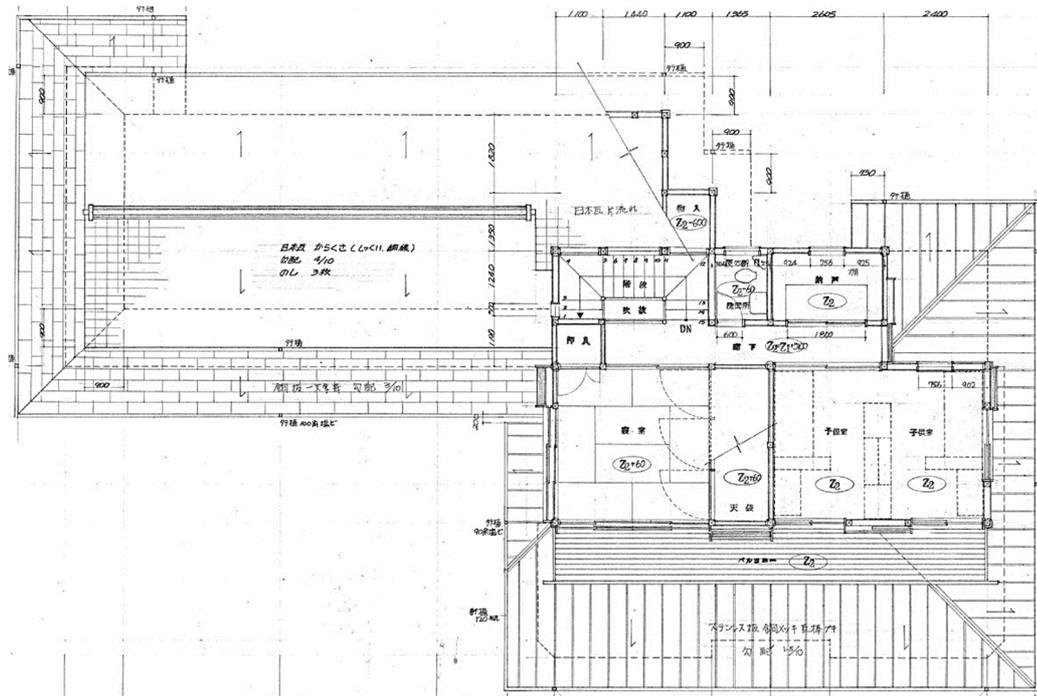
「長谷川邸 (H 邸)」 (1974) 2 階平面図
